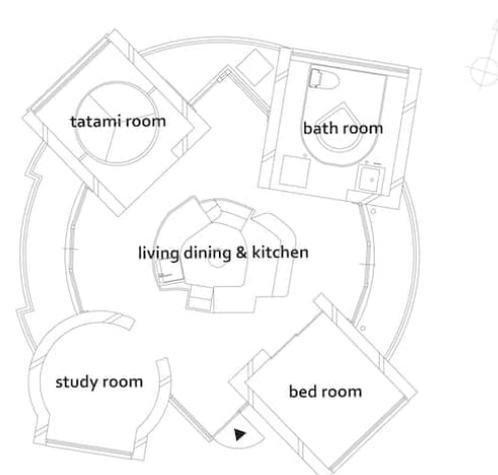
Grundriss Reversible Destiny Lofts, Mitaka
